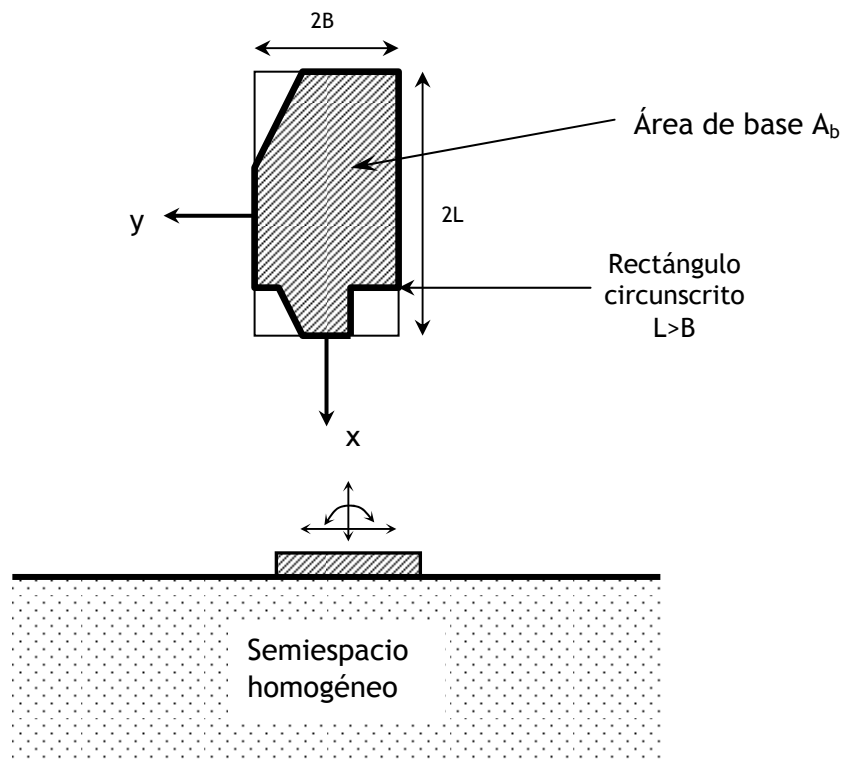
Planta y sección de una cimentación superficial de geometría arbitraria.
